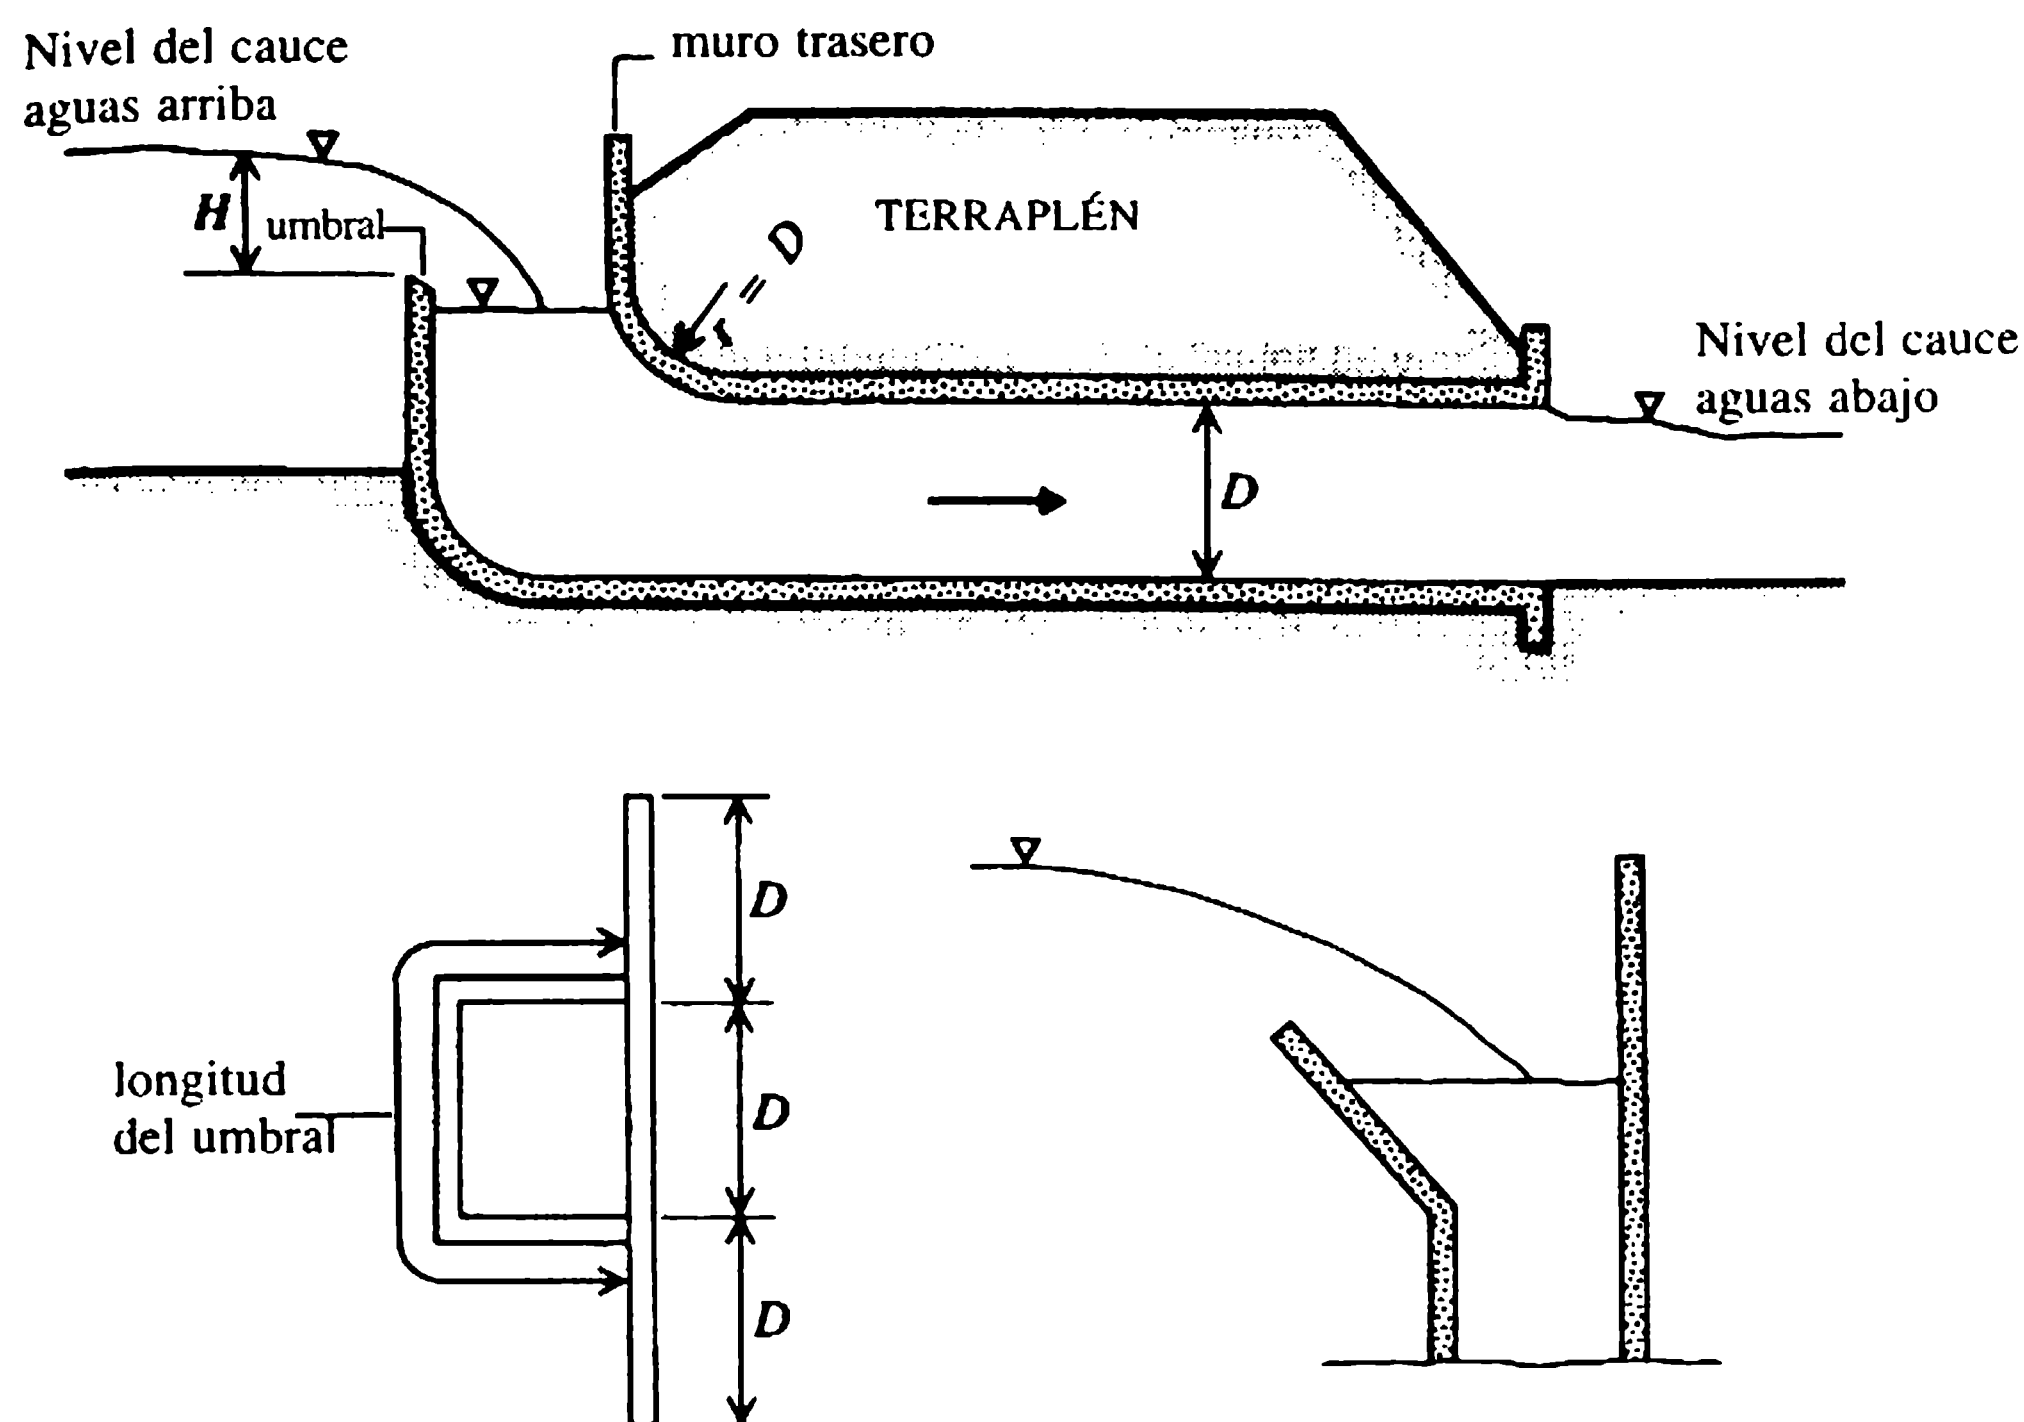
Estructuras de entrada de alcantarillas; vistas en plantas.
